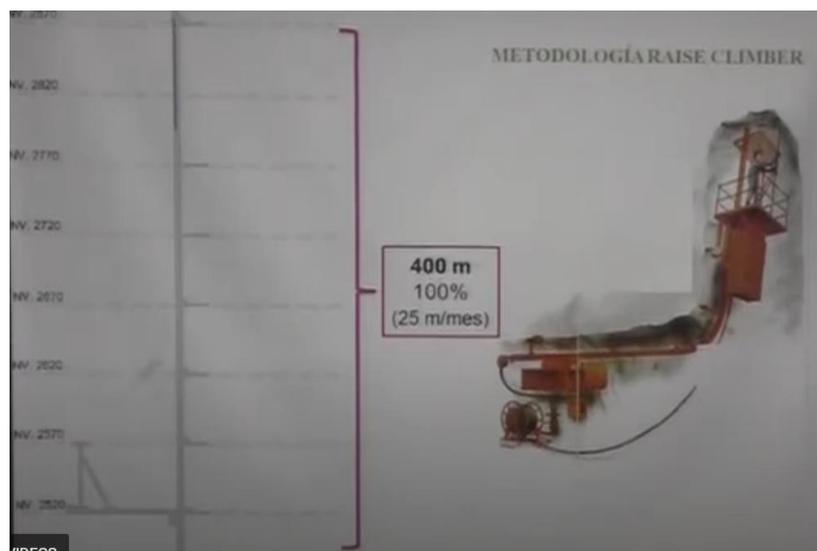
Chimeneas piloto de pique con Raise Borer y con Raise Climber
